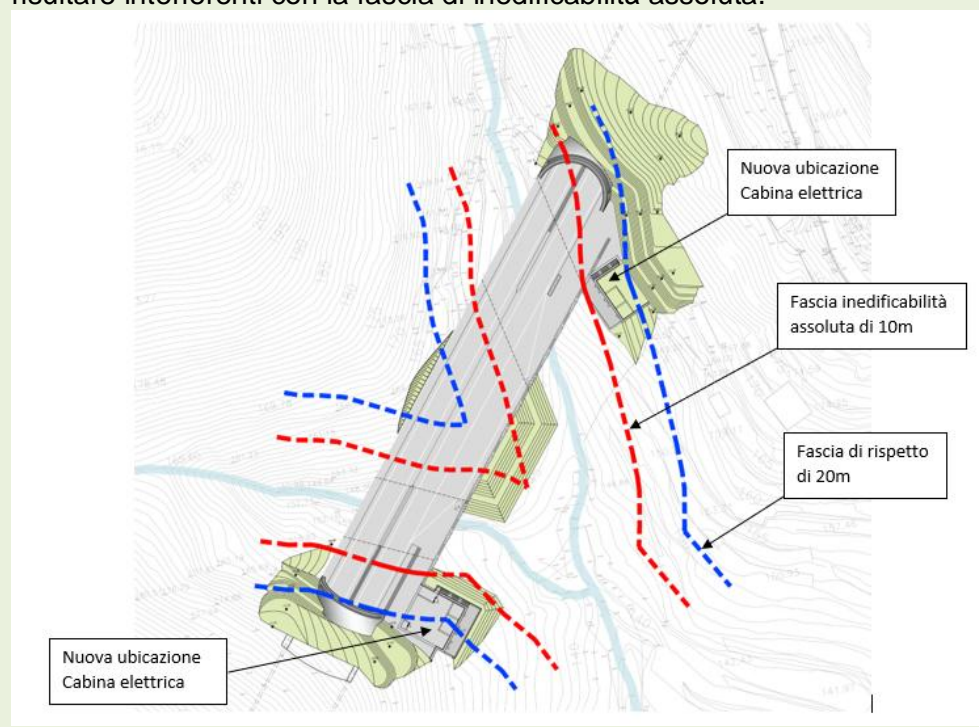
Fasce di inedificabilità e di rispetto Rio Gallo e rio Serra – Nuovo layout progettuale
